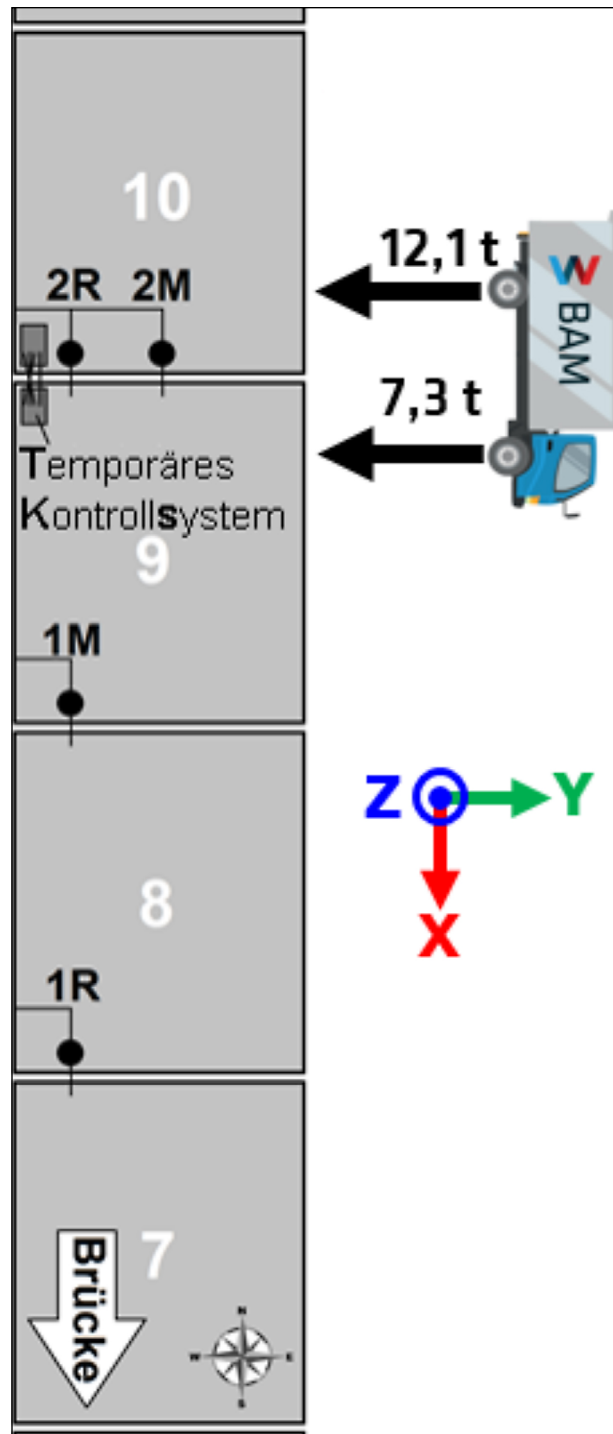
Lageplan der Sensorsysteme mit eingezeichneter Rollrichtung des Lkw und Achslasten
